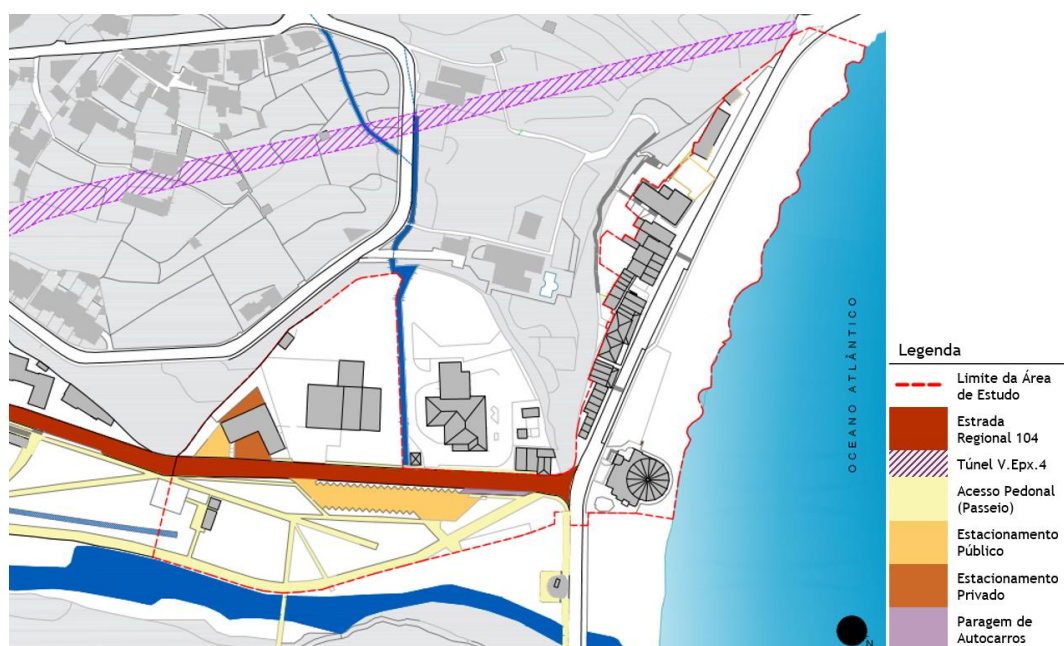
Planta de Caracterização: Infraestruturas. Zona de Equipamentos. [s/escala]
